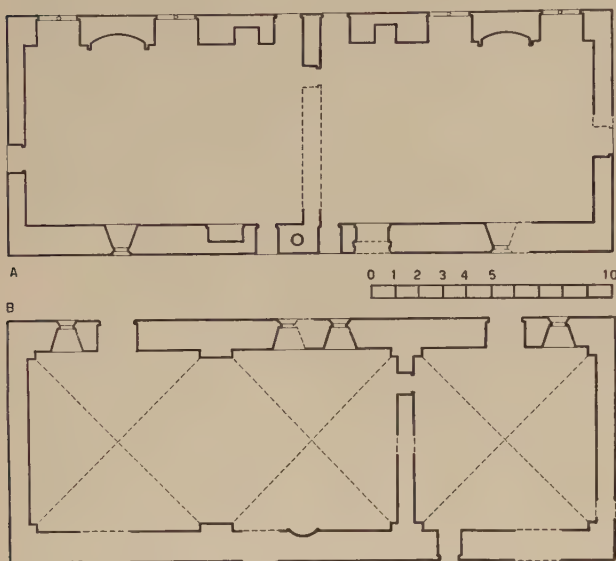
Pianta del piano superiore (A) e del piano terreno (B) della costruzione
